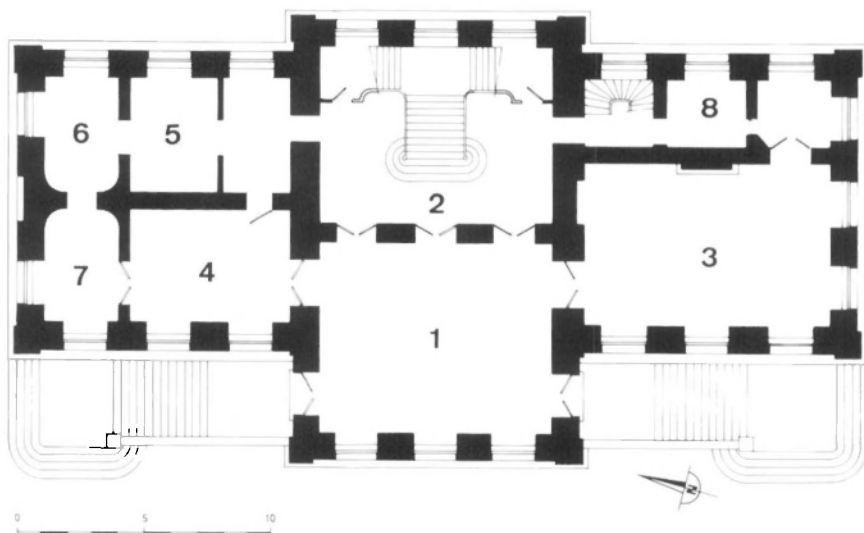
Plan du rez-de-chaussée surélevé (Dessin de Gérard Michel, 1982).
